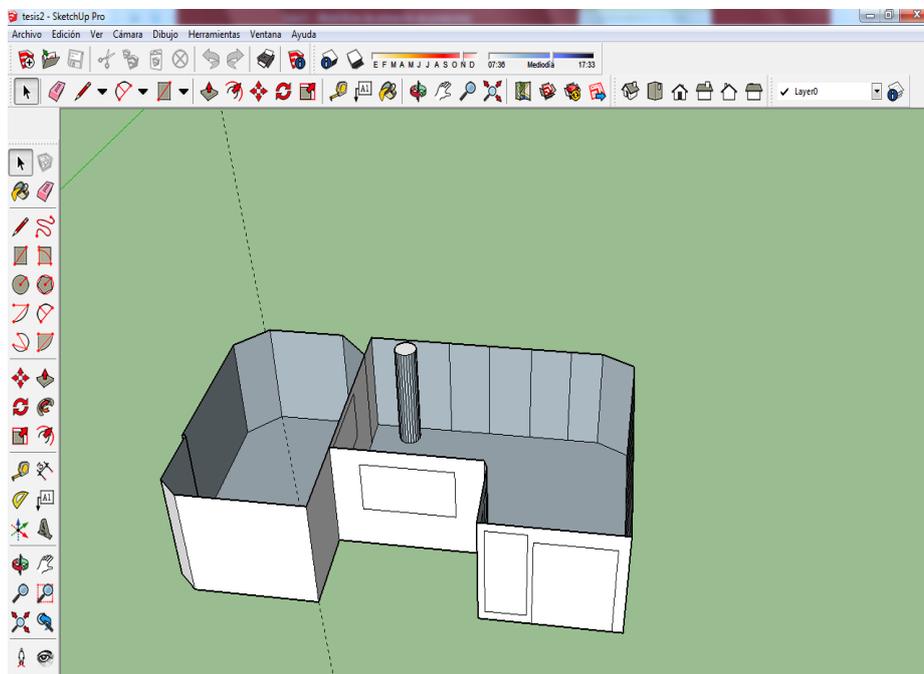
Diseño del plano 3D de las aulas EG1/CR1 en Sketch Up.
